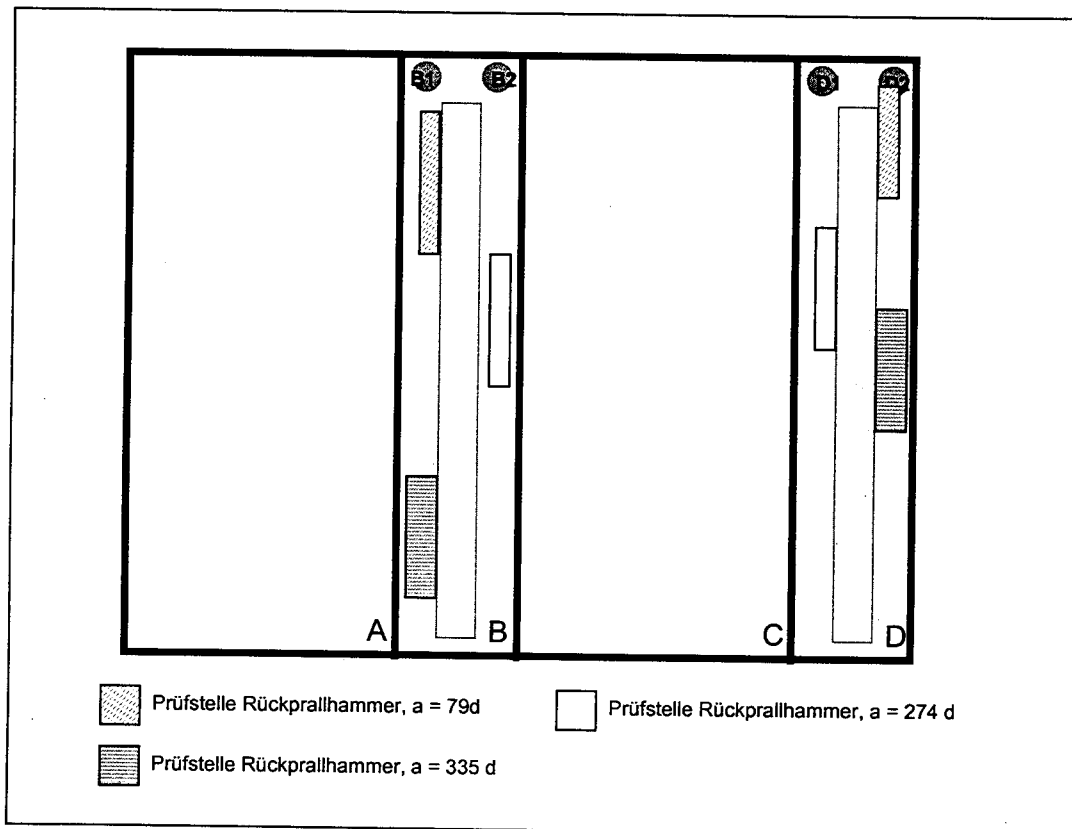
Lage der Prüfflächen am Betonkörper 11
